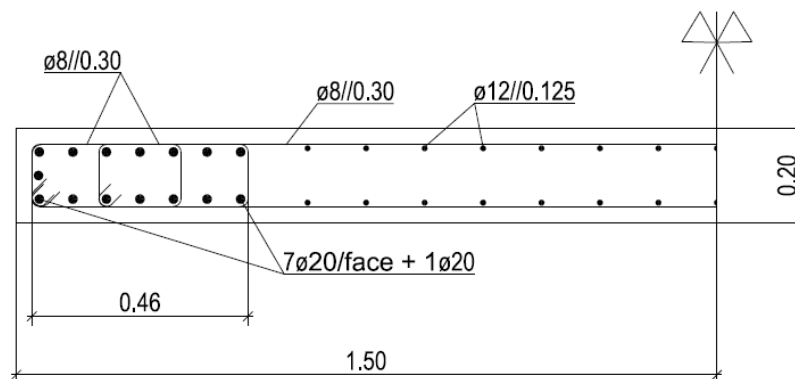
Armadura longitudinal e transversal para as paredes Pa1 a Pa4 para o nível 4
